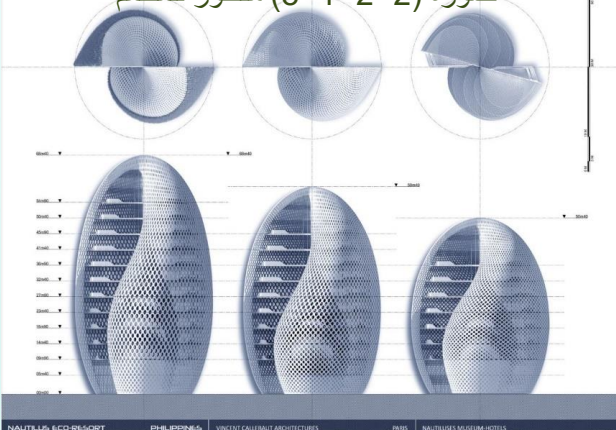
مسقط الأفقي للبراج السكنية
